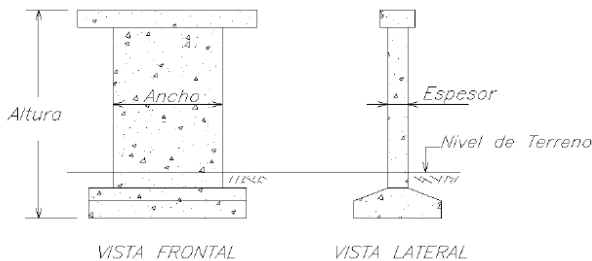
Vista frontal y lateral de una pila tipo muro (MOPT, 2007).
